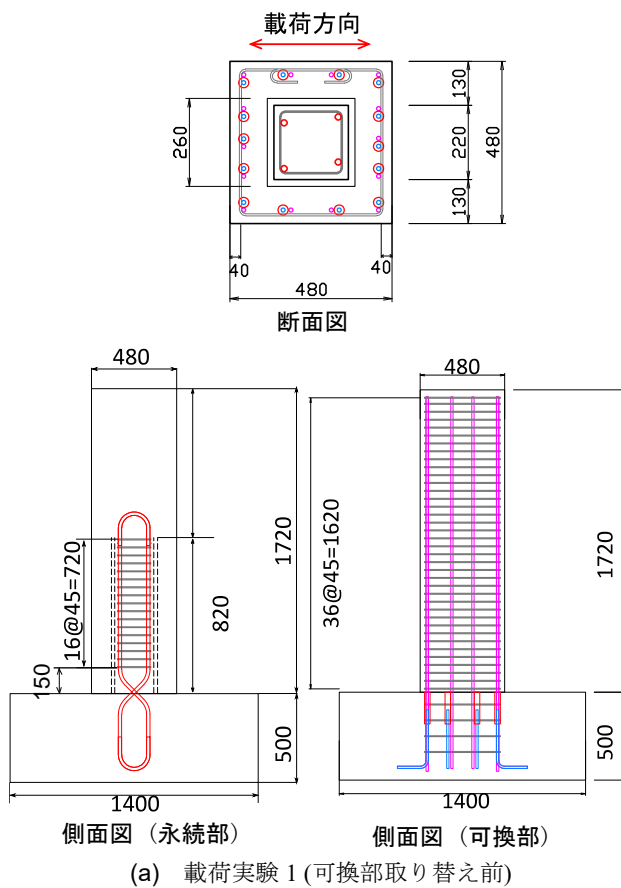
比較供試体<sup>4)</sup>の寸法および配筋図 (Unit:[mm])
